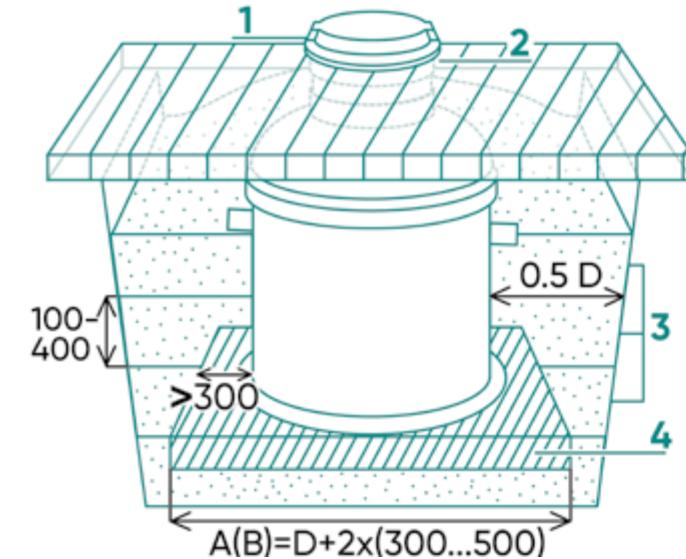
Schema de instalare a unei carcase verticale în zona cu nivelul ridicat de ape subterane² într-o zonă pietonală
